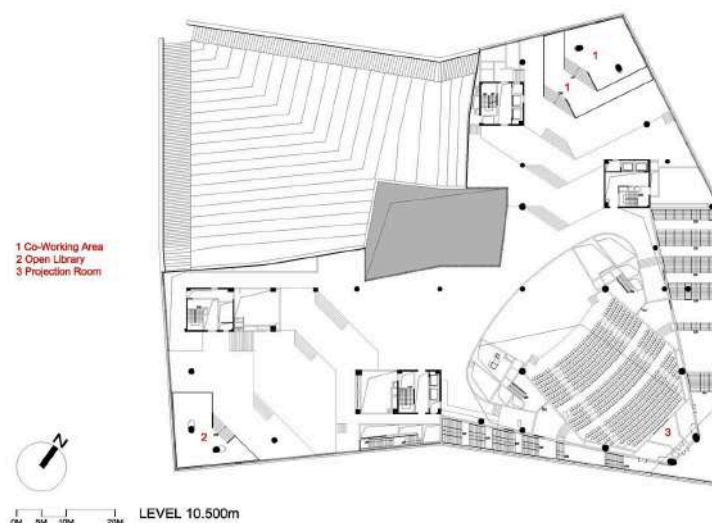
Planta baixa Haier Global - Pavimento 2 - Ambientes de convivência e pesquisa -
